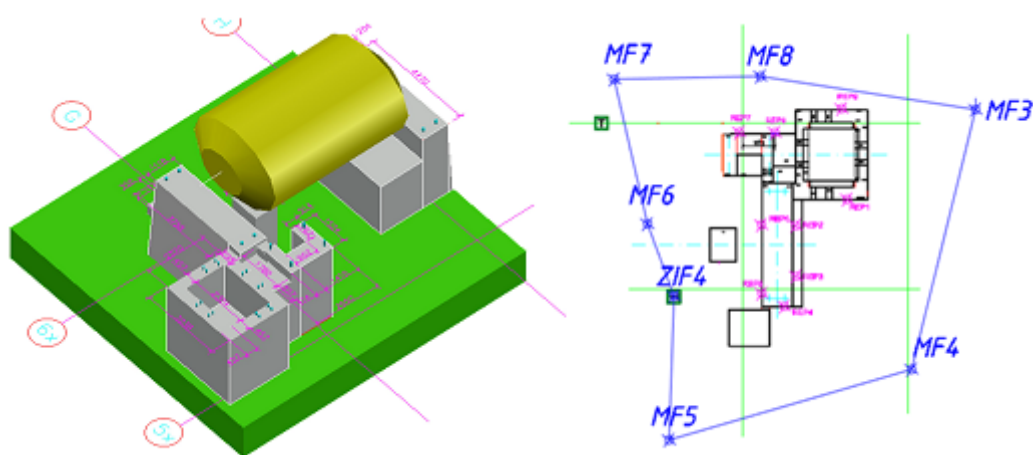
Фундамент мельницы и схема расположения геодезических марок
